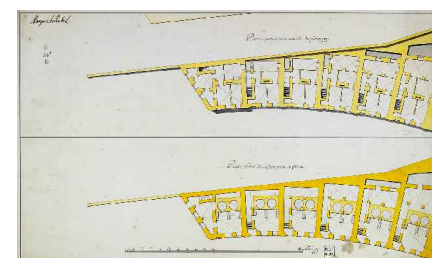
Los hornos en la planta baja y las viviendas en el primer piso, firmado por el marqués de Pombal.
